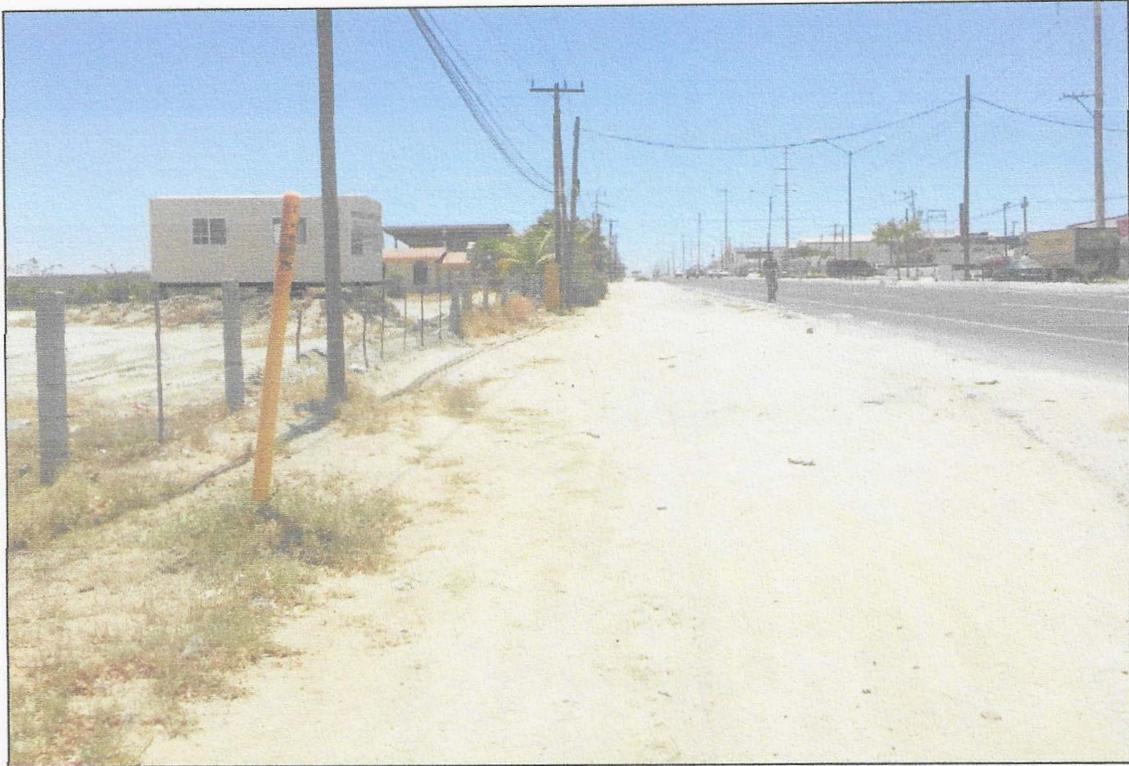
Vista lateral del predio donde se pretende instalar el proyecto.
